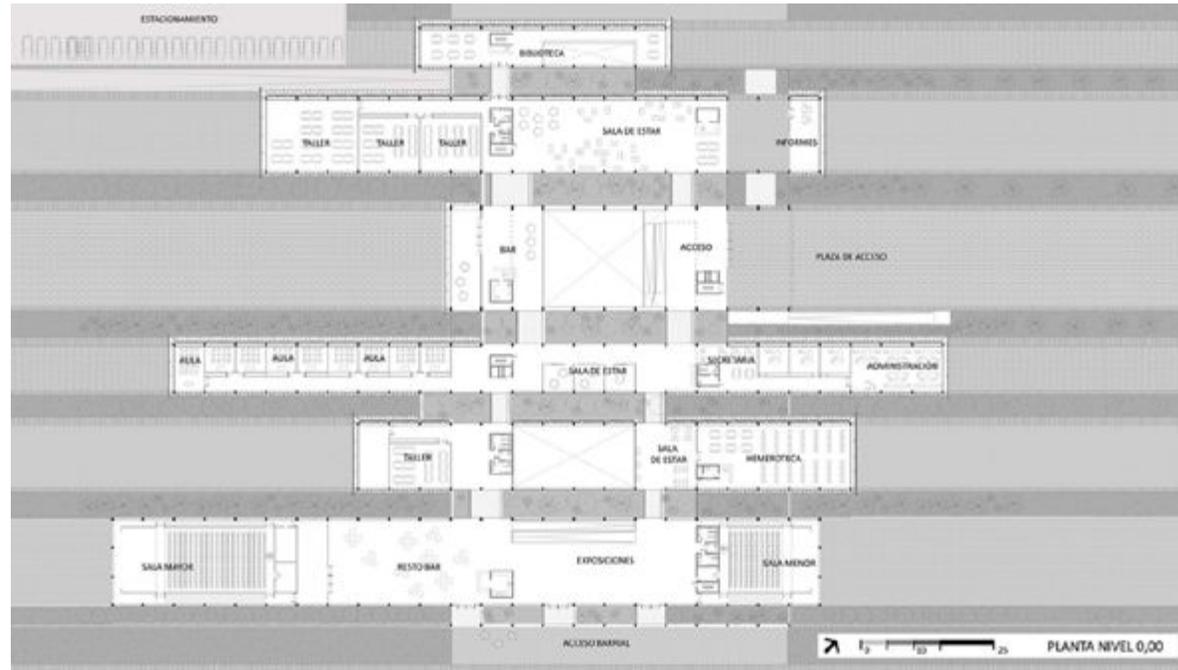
Planta nivel 0,00. Autoría: Elaboración propia
